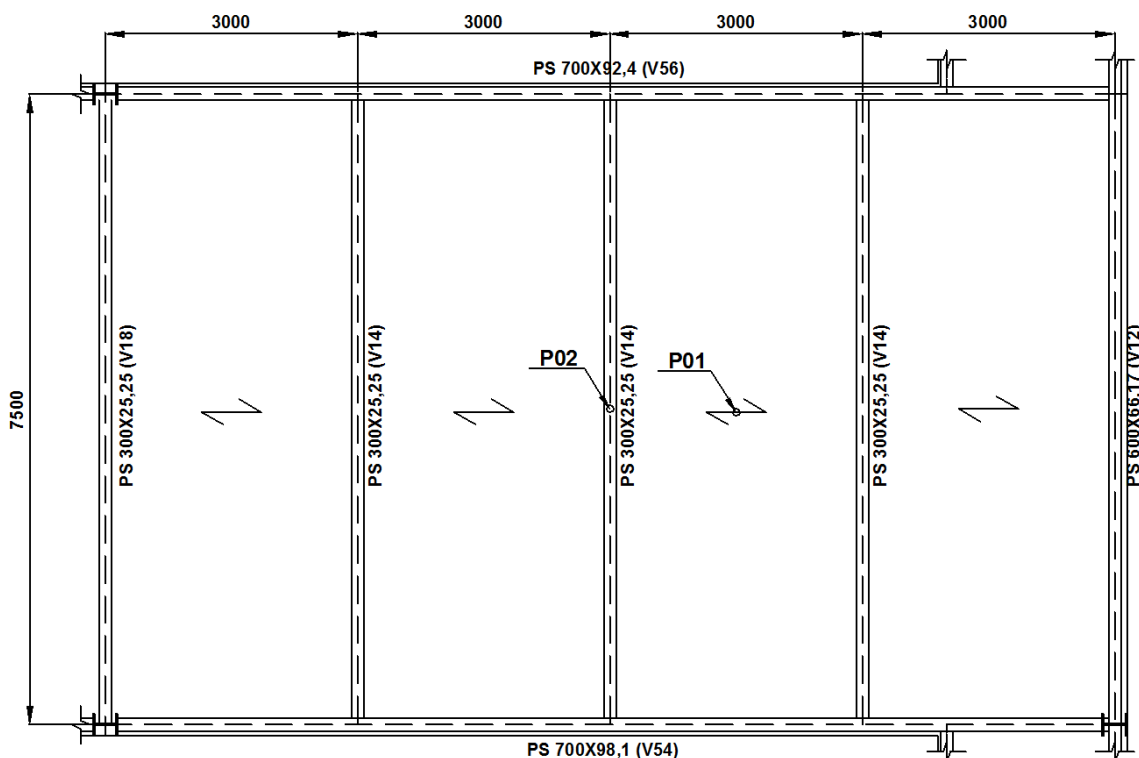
Plano das vigas da região 3 com posicionamento dos acelerômetros.
